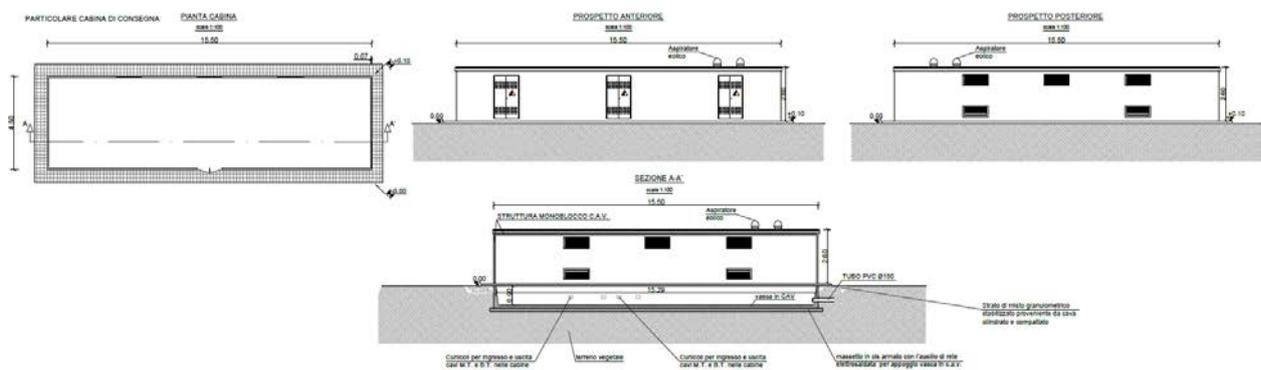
Pianta e sezione della cabina di raccolta e consegna MT
